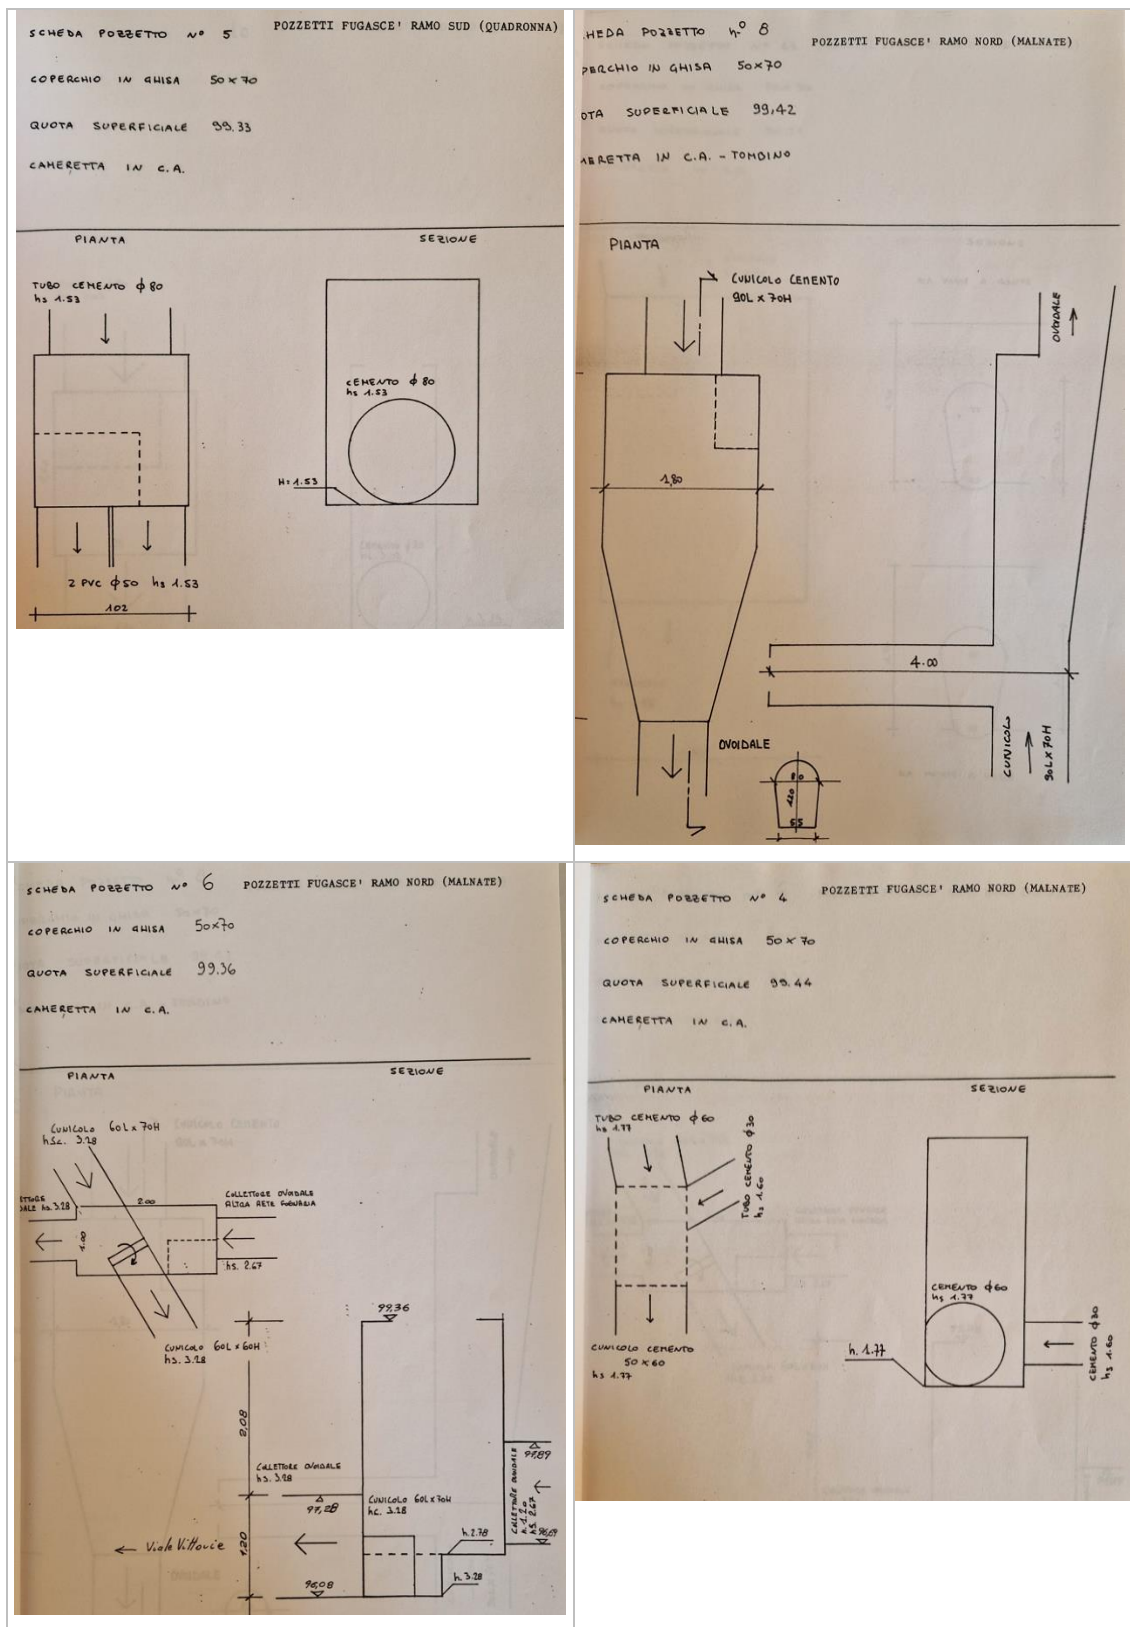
Immagini delle planimetrie dello scolmatore del Fugaschè (planimetria del primo tratto di monte, piante e sezioni di alcune camerette e manufatti) 2/2
